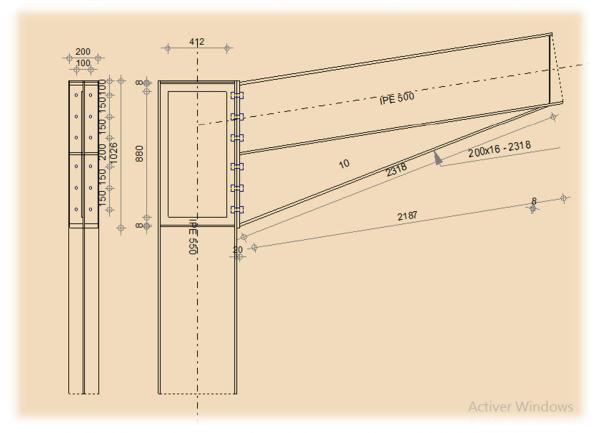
Détail d'assemblage poteau - traverse (IPE550-IPE500)
